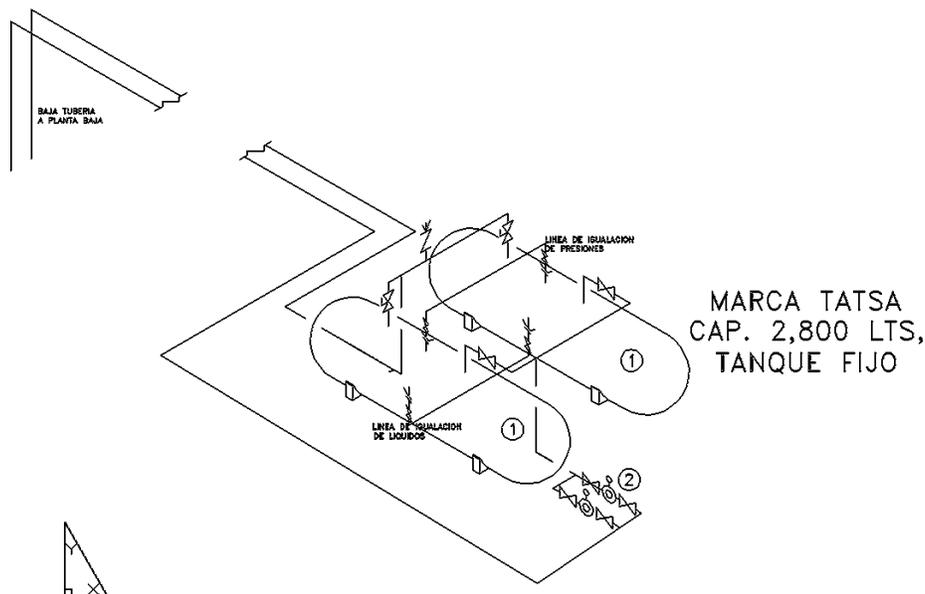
Detalle de Instalación de los tanques de gas LP que serán instalados en la azotea del proyecto.
